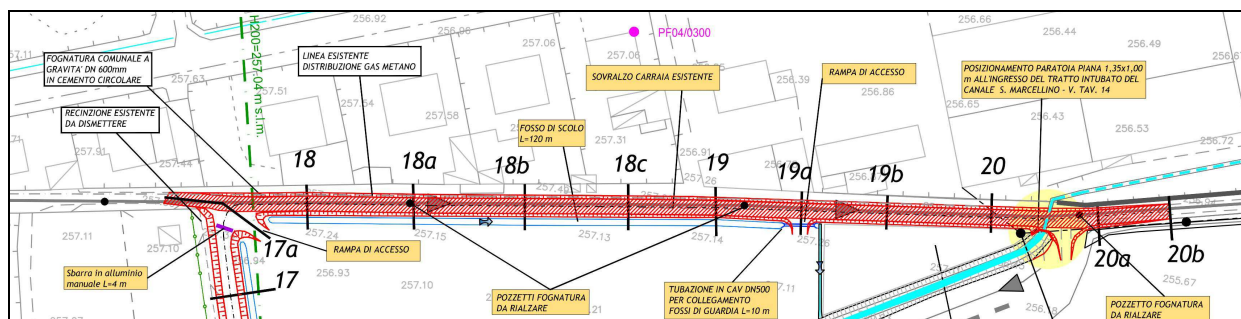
Particolare della planimetria di progetto di sponda sinistra, con indicati i pozzetti fognari da sovralzare
